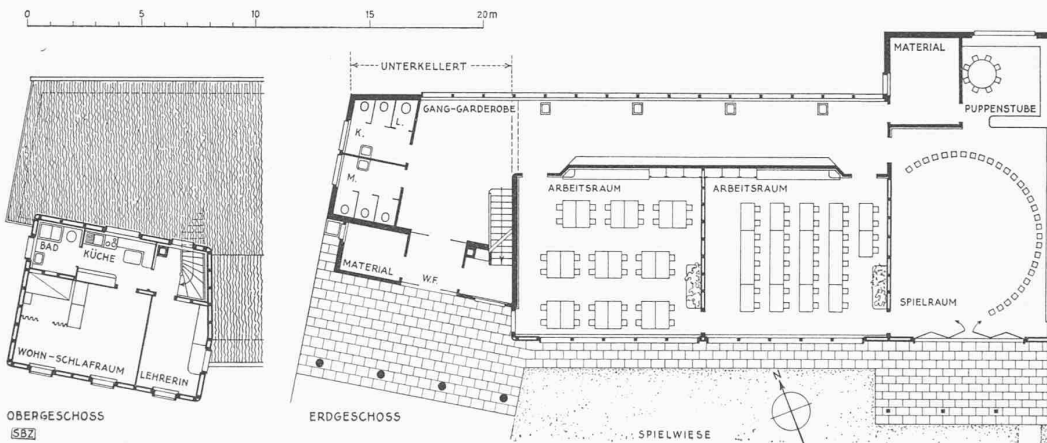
Grundrisse vom Erdgeschoss und Obergeschoss
